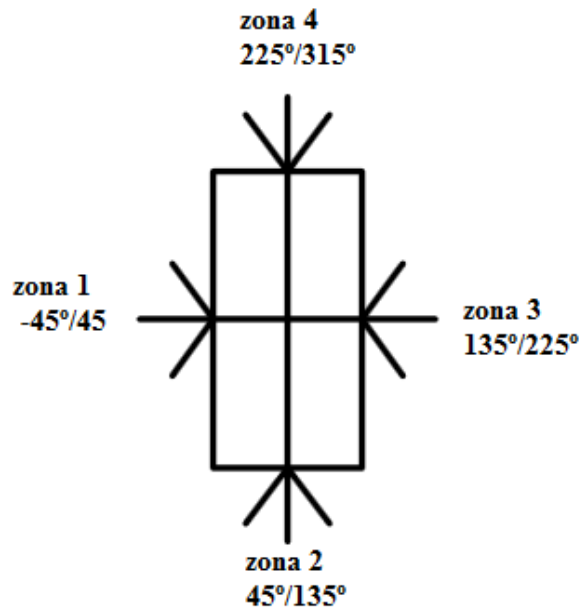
48. Planteamiento de la nave para abarcar cualquier dirección del viento.
